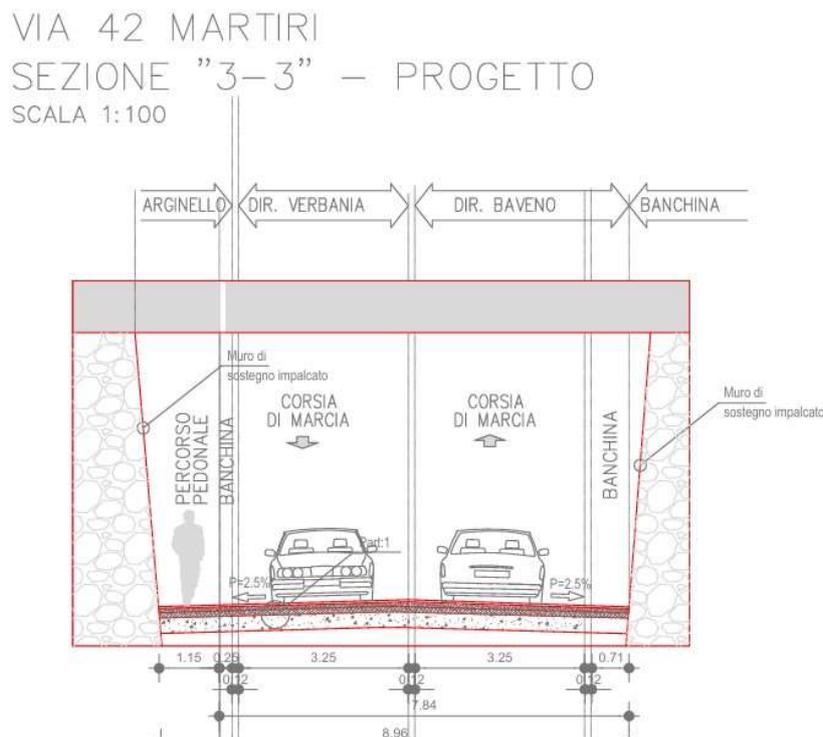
SEZIONE N.3 DI PROGETTO-TRATTO STRADALE ALL'ALTEZZA DEL SOTTOVIA DI VIA VIA CAVAGGI
